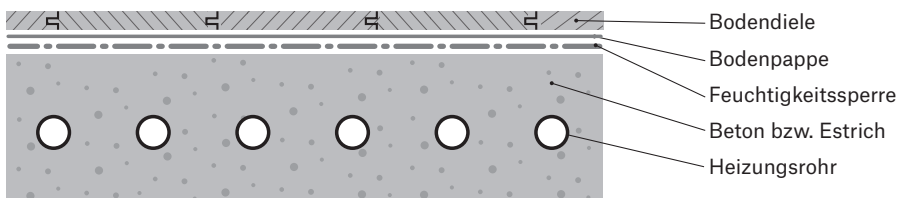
Querschnitt direkt auf Beton bzw. Estrich mit Heizungsrohren
